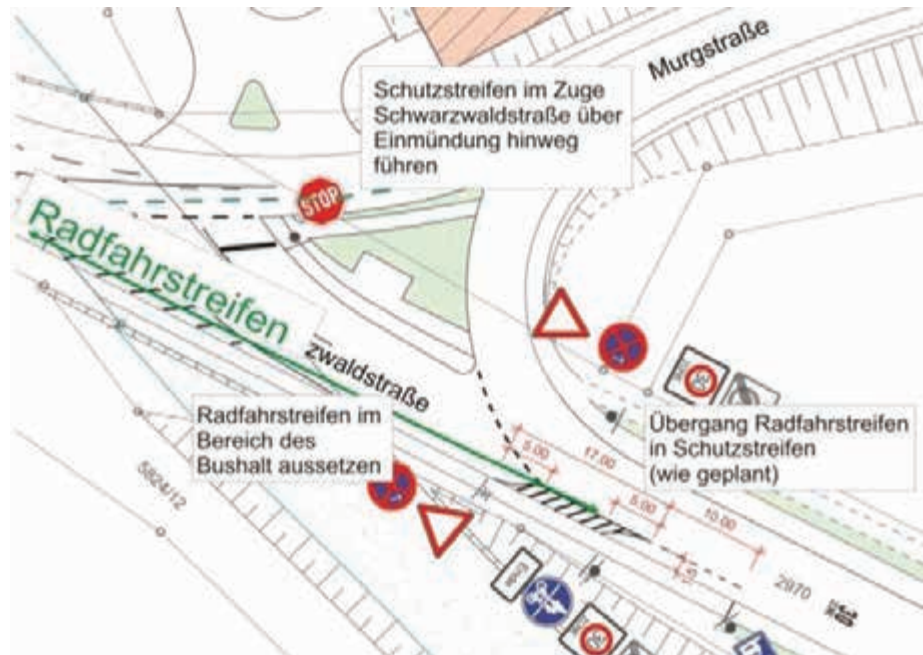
Ergänzende Empfehlungen zur Planung Murgstraße /Schwarzwaldstraße
